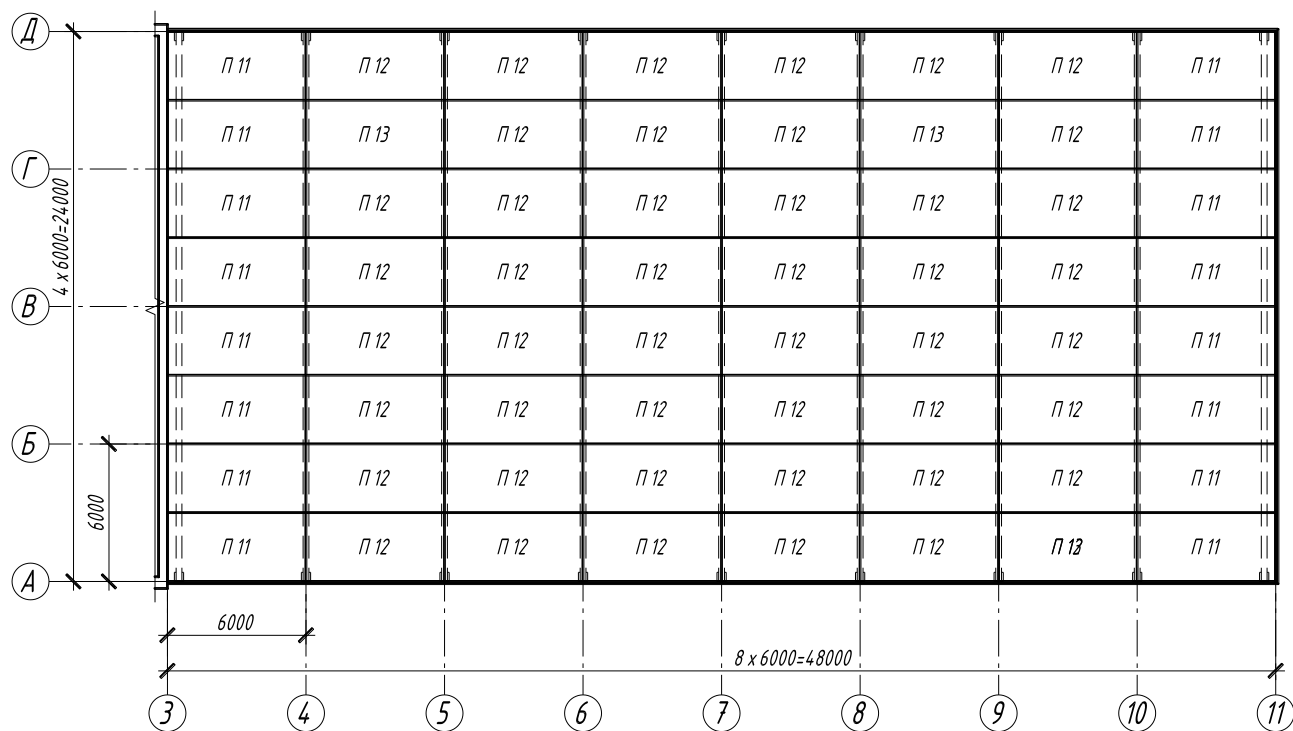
Схема розташування плит перекриття на відм. +4,800
